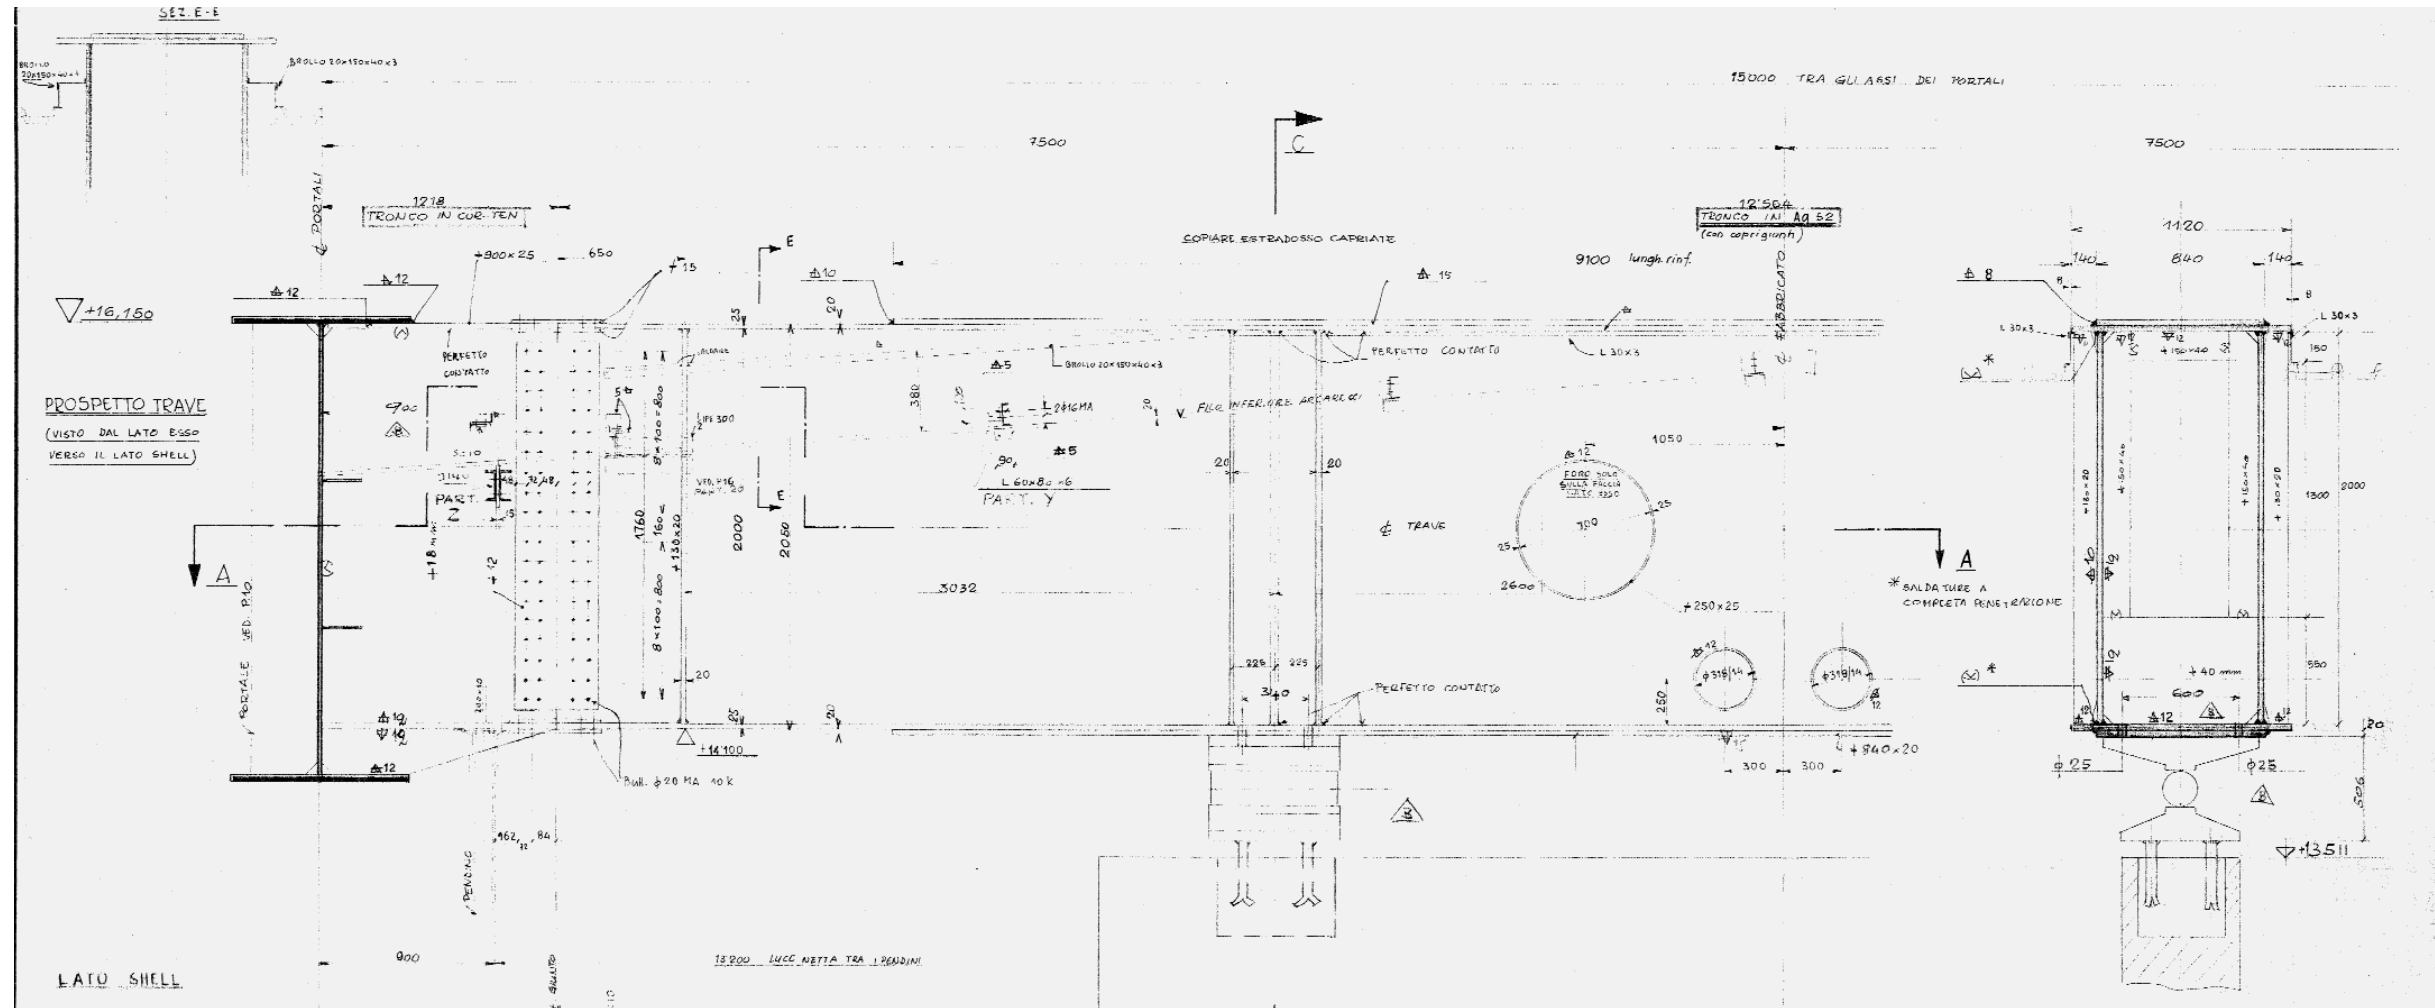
Prospetto e sezione della trave a cassone Elaborati di progetto della C.M.F. (AAB)
